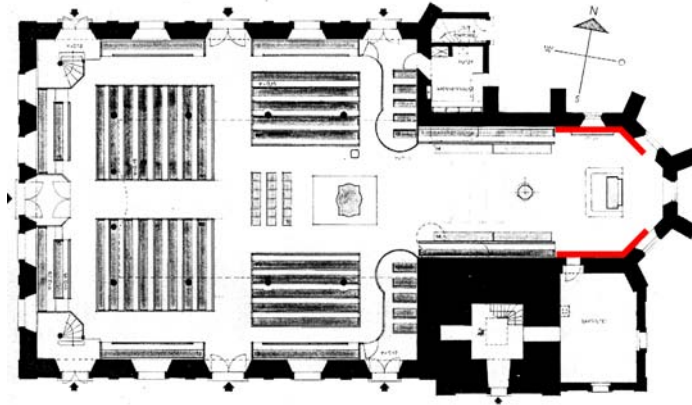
Grundriss der Laurentiuskirche in Altdorf mit Lage der metallenen Grabplatten, siehe rote Markierungen. Der Grundriss ist MEYER (1986) S. 27 entnommen.
